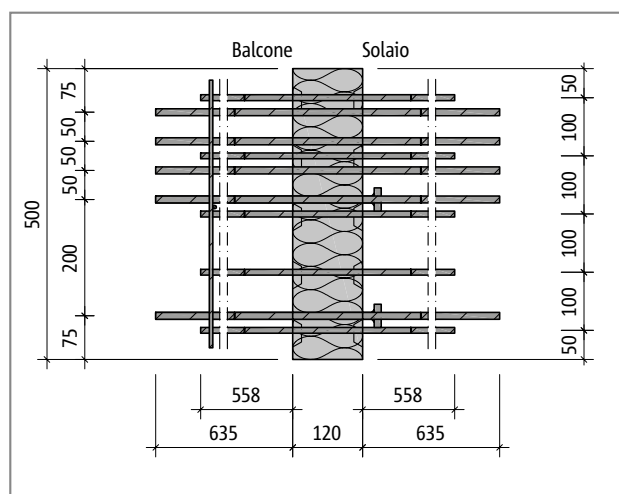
Schöck Isokorb® tipo EXT30-L-V10: pianta del prodotto
